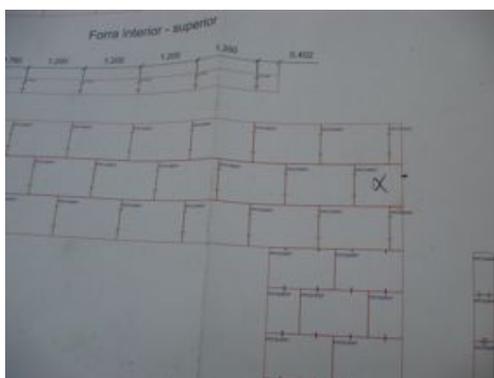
Plano de montagem do revestimento usado na obra, com indicações das pedras a usar e localização dos gatos metálicos
